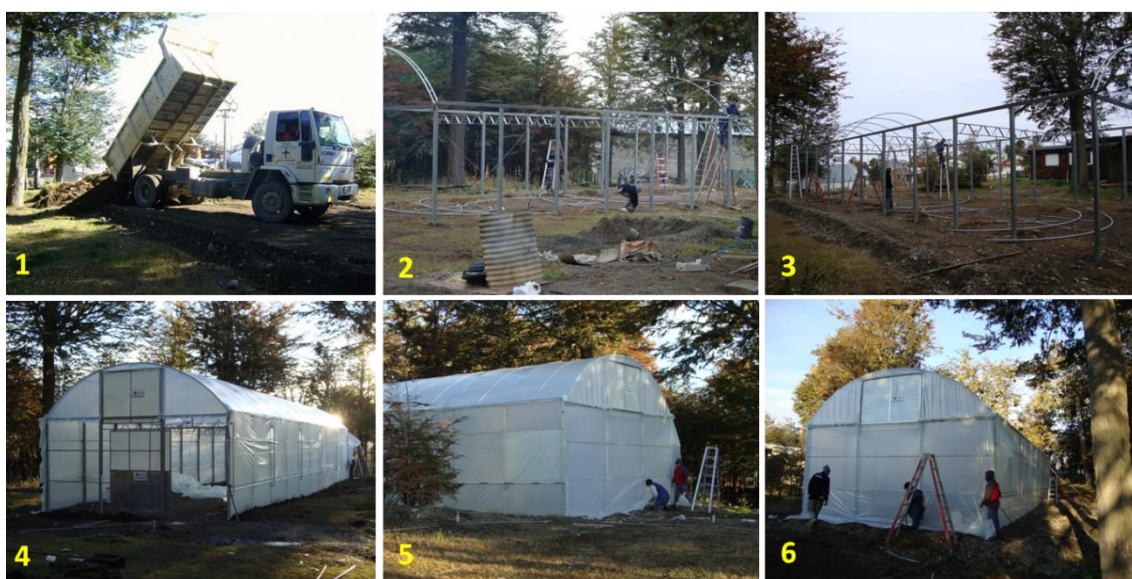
(1) Relleno con material gravoso para instalar la estructura. (2-3) Armado de la estructura
